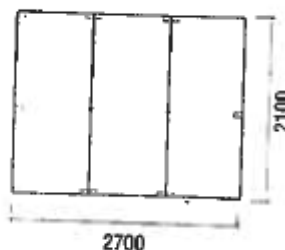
Rendimentos padrão para a aplicação dos vidros do elevador panorâmico, [3]
